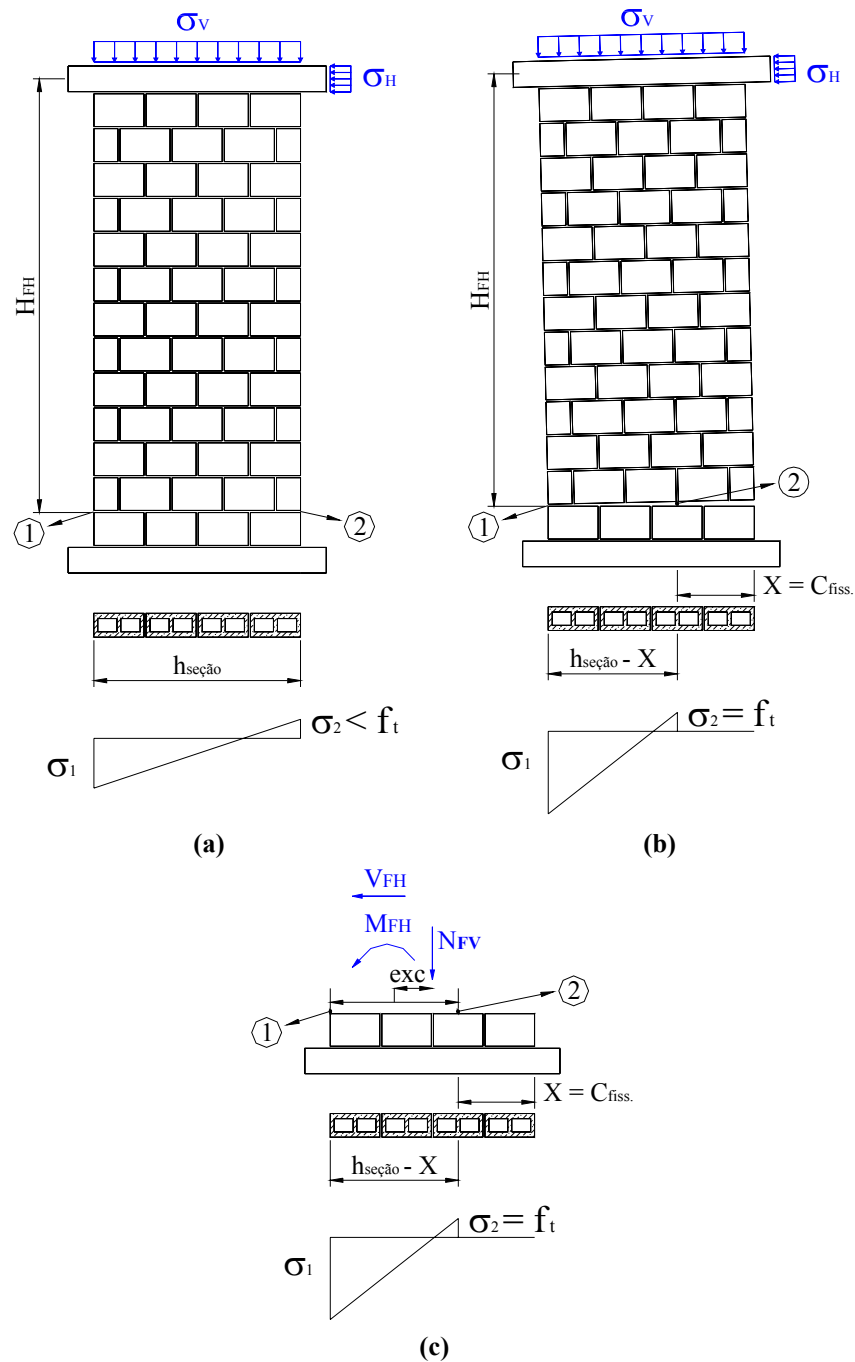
Modificação das tensões na 1ª junta horizontal com o desenvolvimento de sua fissuração: (a) Trações com intensidade menor que f_t ; (b) Ocorrência de fissuração com correspondente zeragem das trações; e (c) Equivalência estática dos esforços na 1ª junta horizontal.
